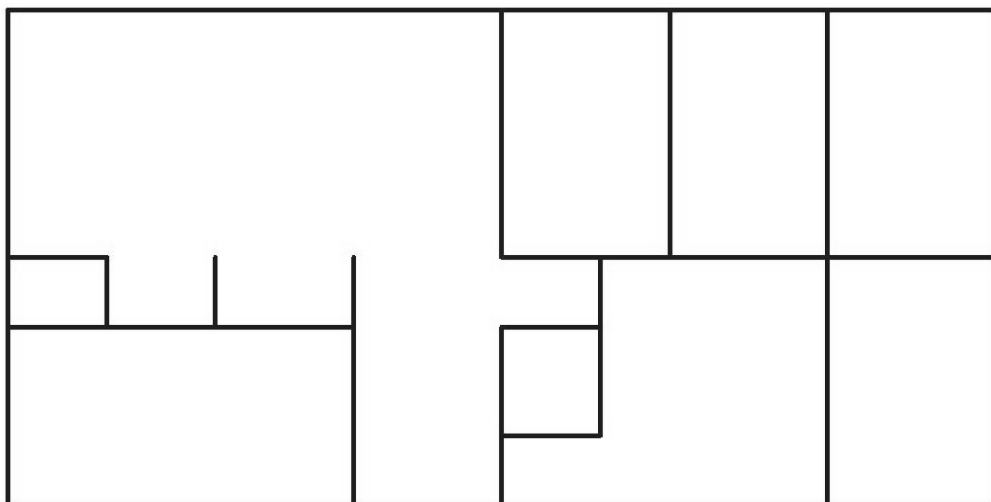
Imagen del plano de la planta anterior en formato .jpg
